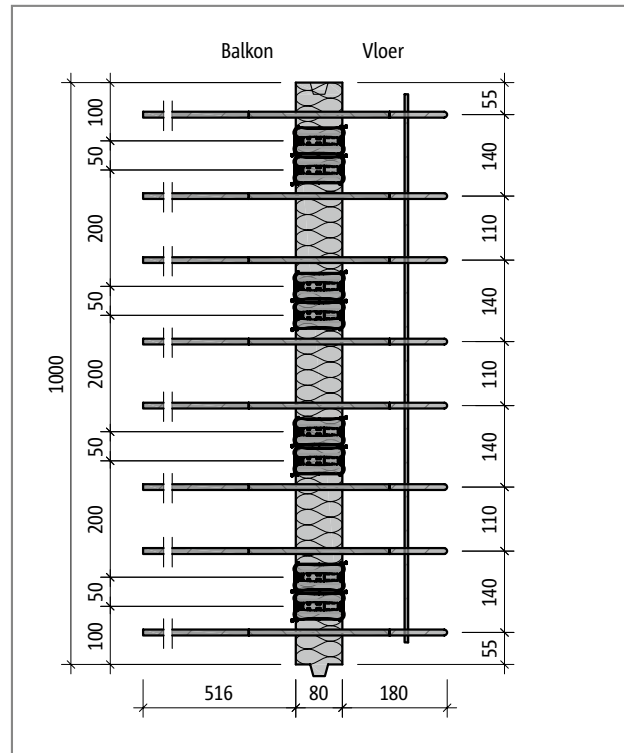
Schöck Isokorb® T type Q-E-V5: Zijaanzicht
